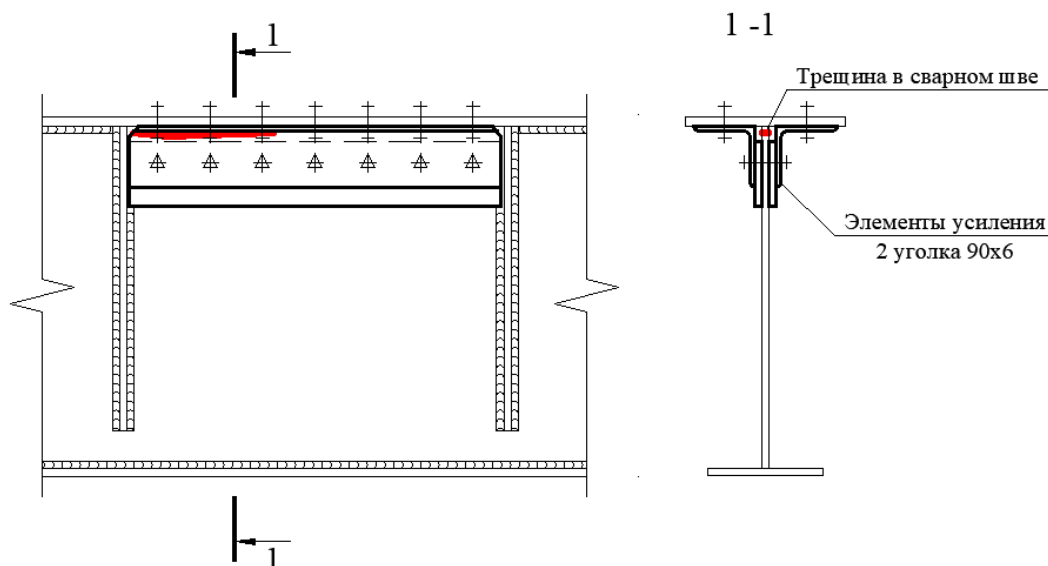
Схема усиления сжатого пояса подкрановой балки с усталостной трещиной
